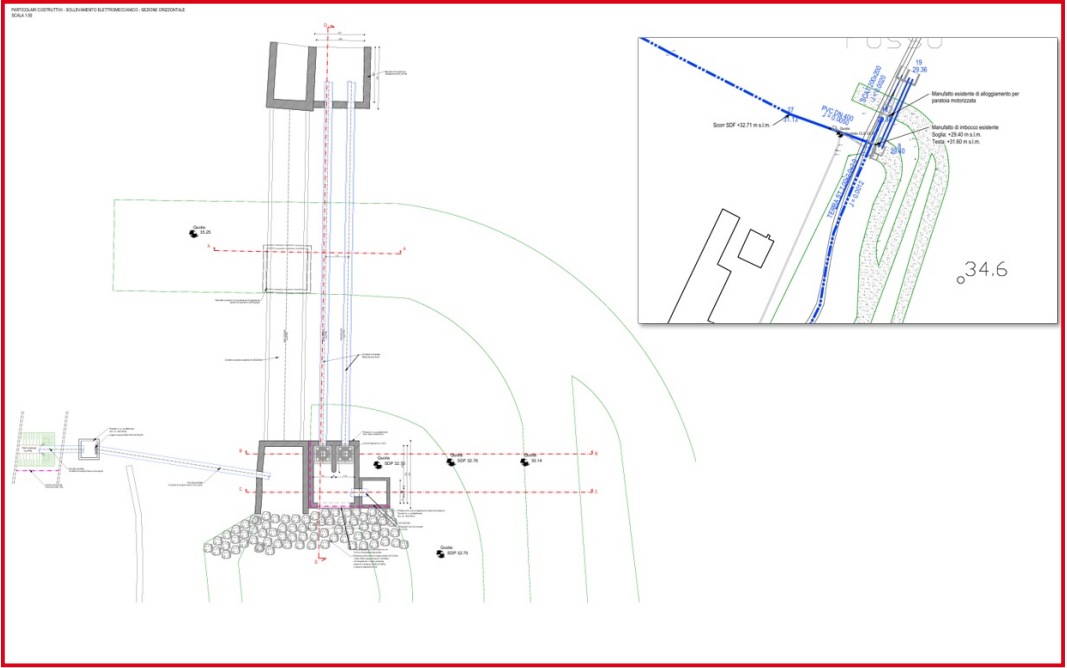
Sezione orizzontale dell'impianto di sollevamento elettromeccanico (documentazione fornita dalla Committenza)
